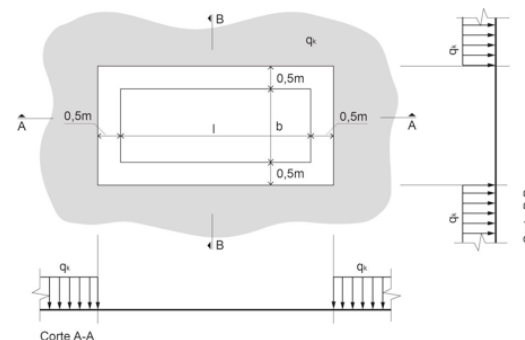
Cargas uniformemente distribuídas ao redor de empilhadeiras ou minicarregadeiras
